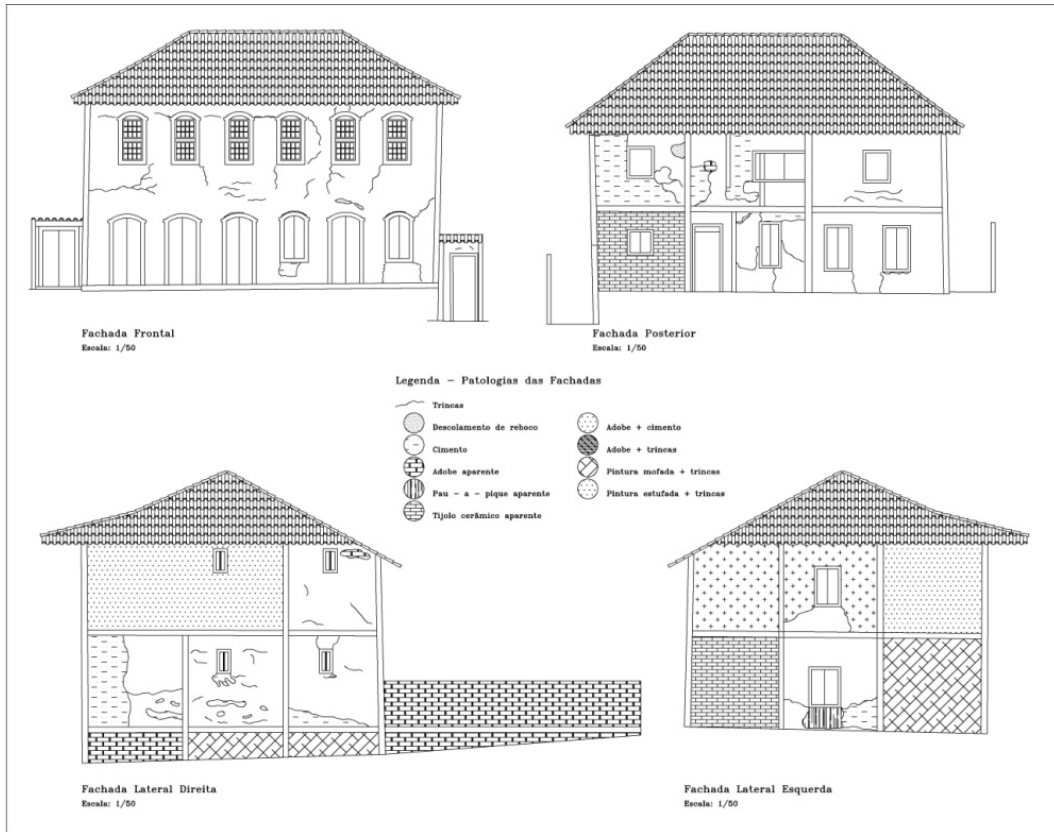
Levantamento das fachadas, realizado em 2006/7 do Sobrado do Cartório. (Fonte: Peixoto, 2007)
